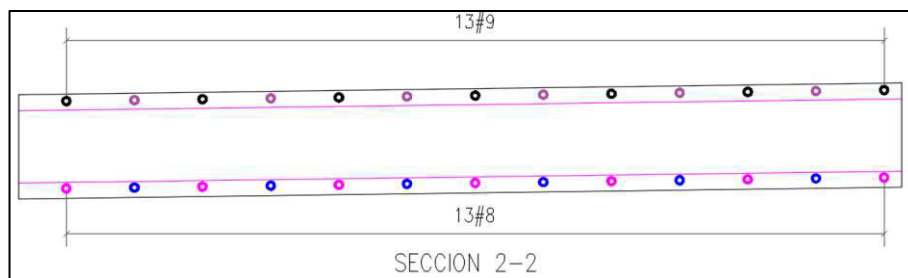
Refuerzo suministrado corte 2-2 – FIN
